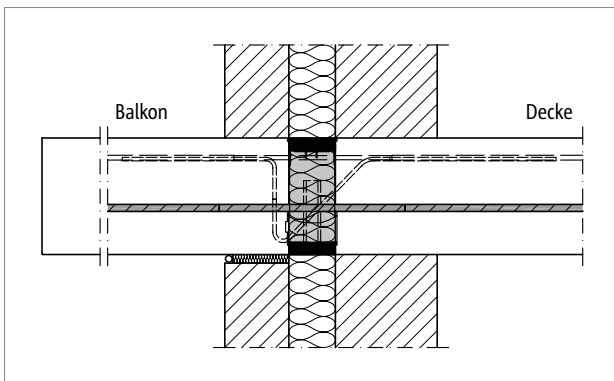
Schöck Isokorb® T Typ KL, HP-NN: Mauerwerk mit Kerndämmung
